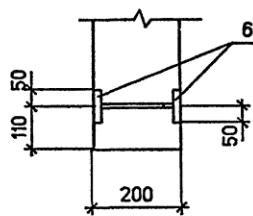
Для крепления связей к средним фермам в покрытии с прогонами при сейсмических нагрузках
